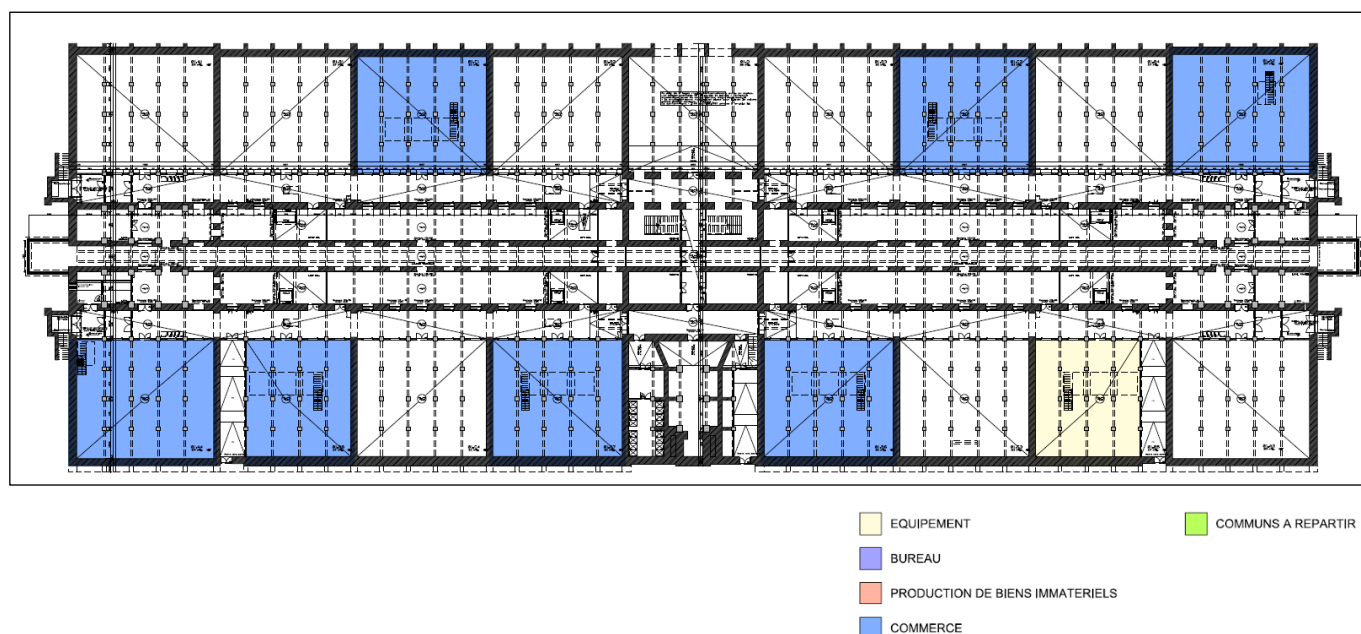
, Bâtiment B, situation existante de droit – rez-de-chaussée
